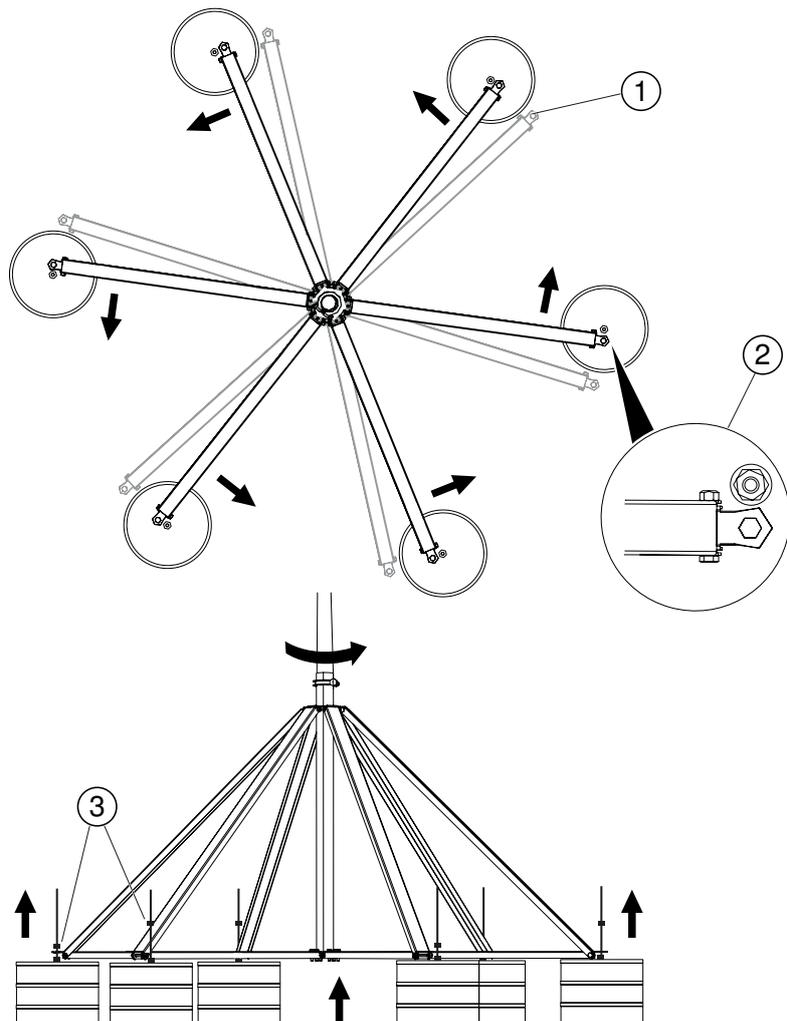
Positionierung Fangmastständer neben und auf Betonsteinsöckeln
